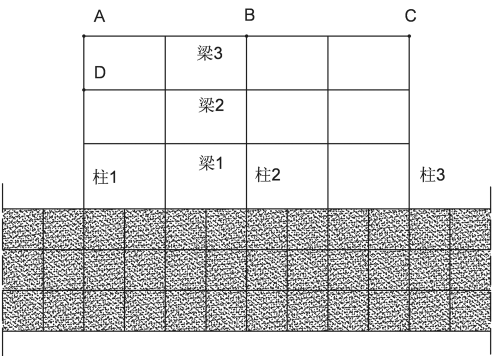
钢筋混凝土框架结构整体模型纵向一榀框架
